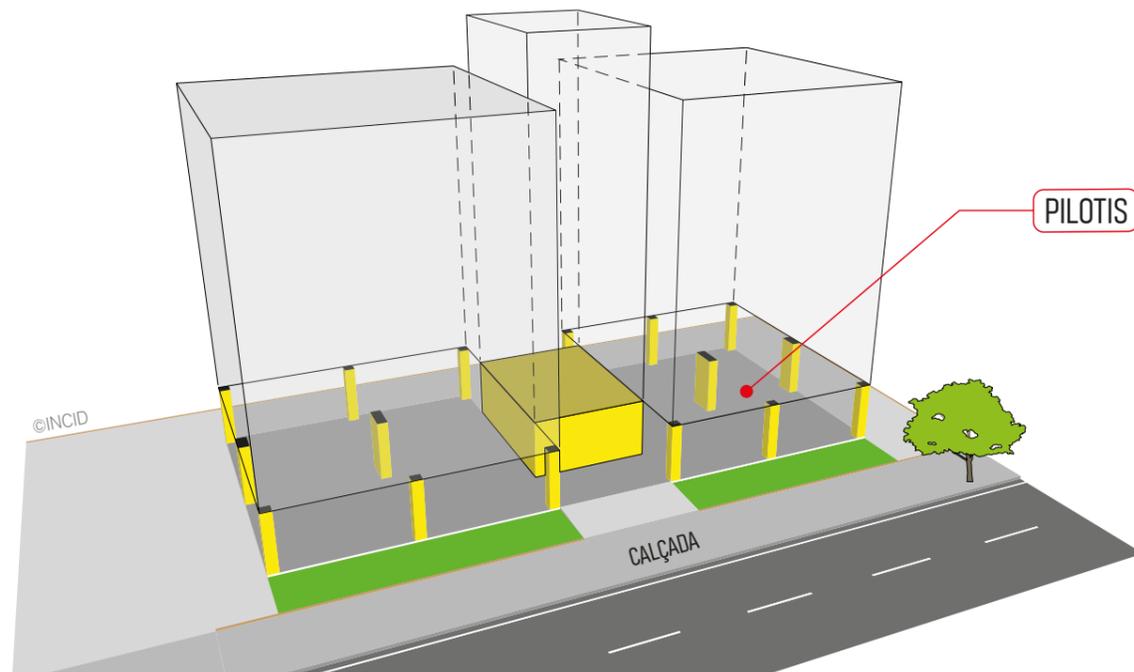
PILOTIS DE UMA EDIFICAÇÃO
